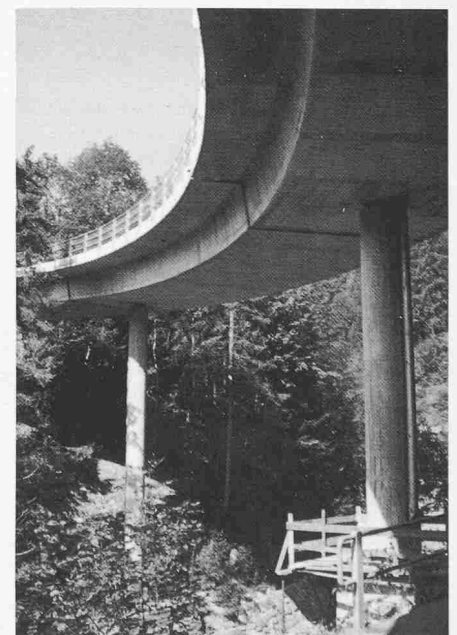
Brückenuntersicht mit Pfeilern und Gerüst zur Lagerregulierung
